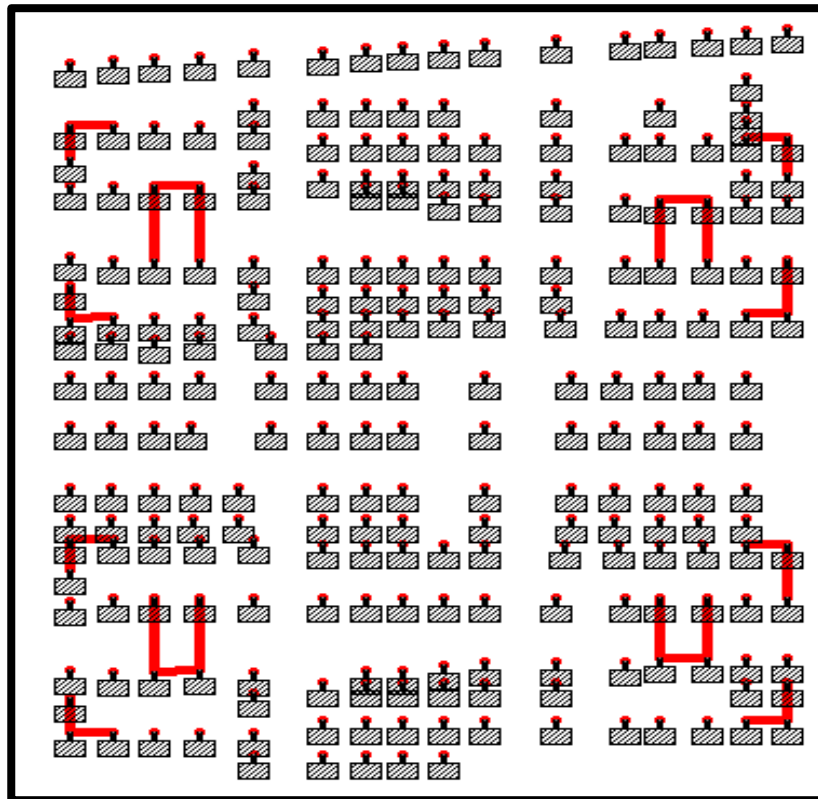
Muestra localización en planta de columnas. Fuente: Los autores
